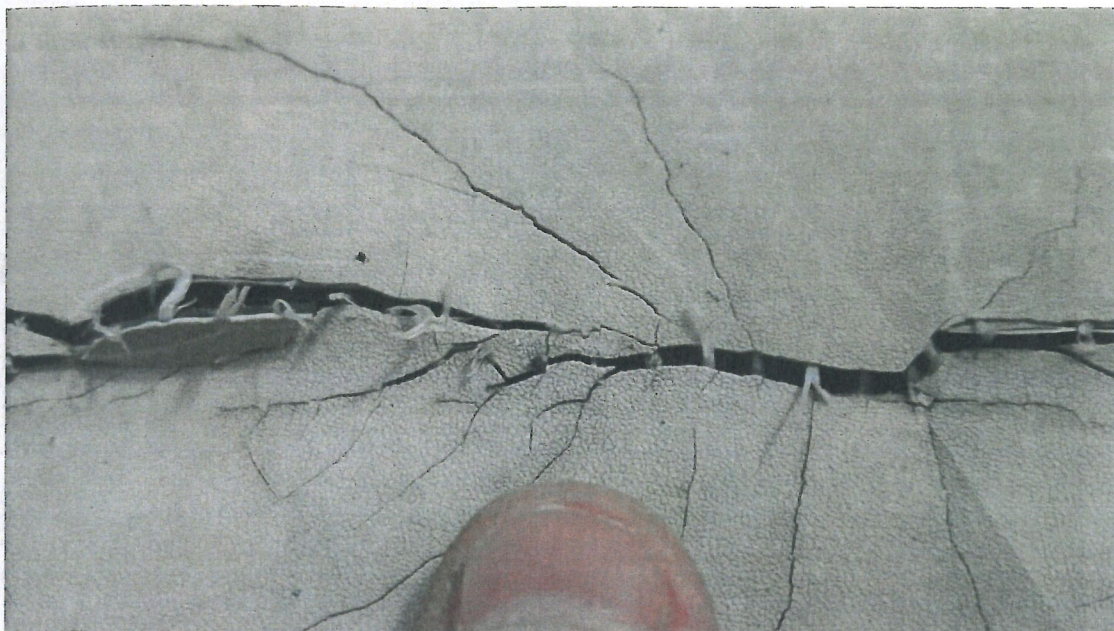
pohled na povrch materiálu kde je vidět obecně narušená struktura
